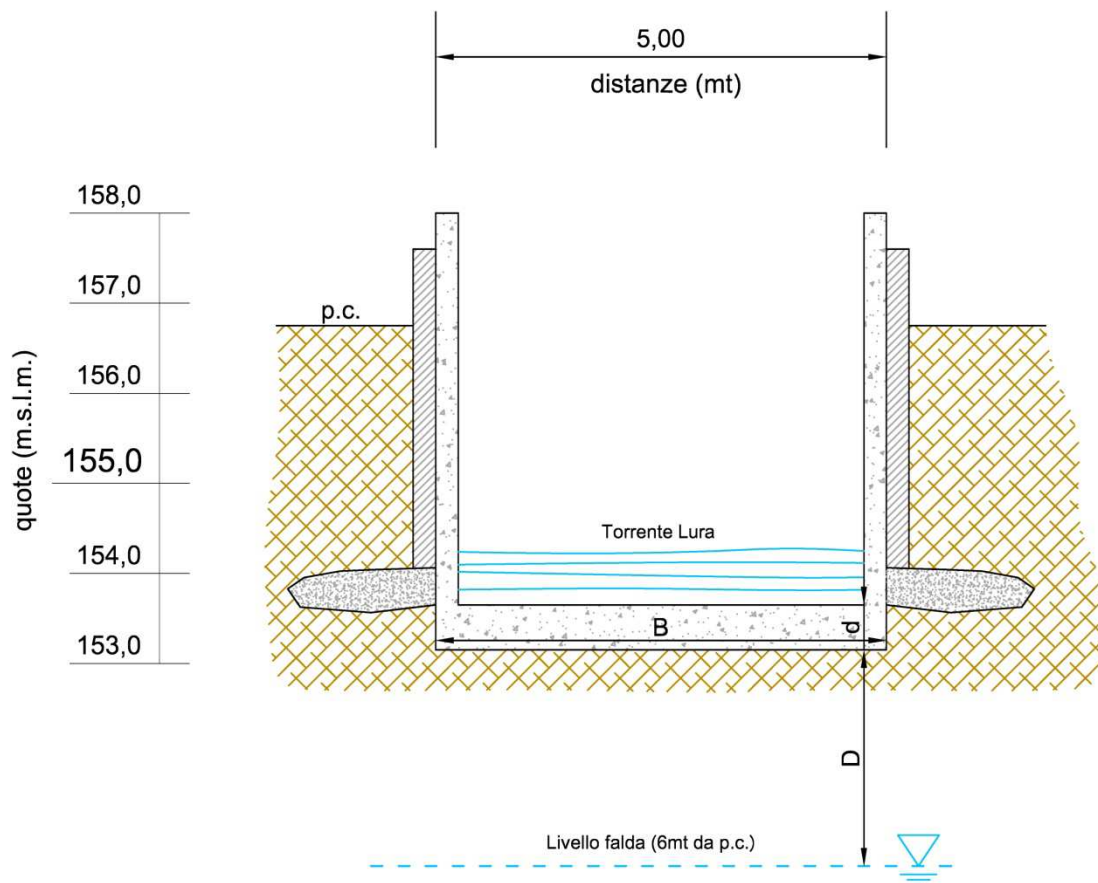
Sezione tipo con individuazione del piano di posa e del livello della falda rispetto al piano campagna.
